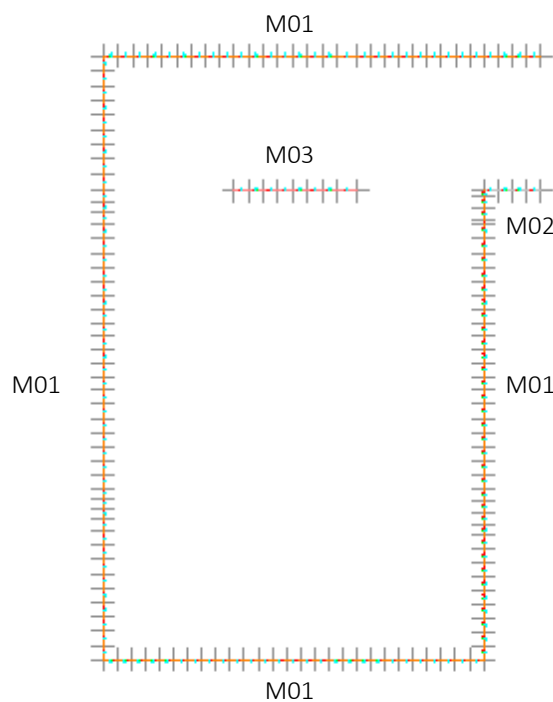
Tipologías de muros de sótano. Fuente: elaboración propia mediante SAP2000.
